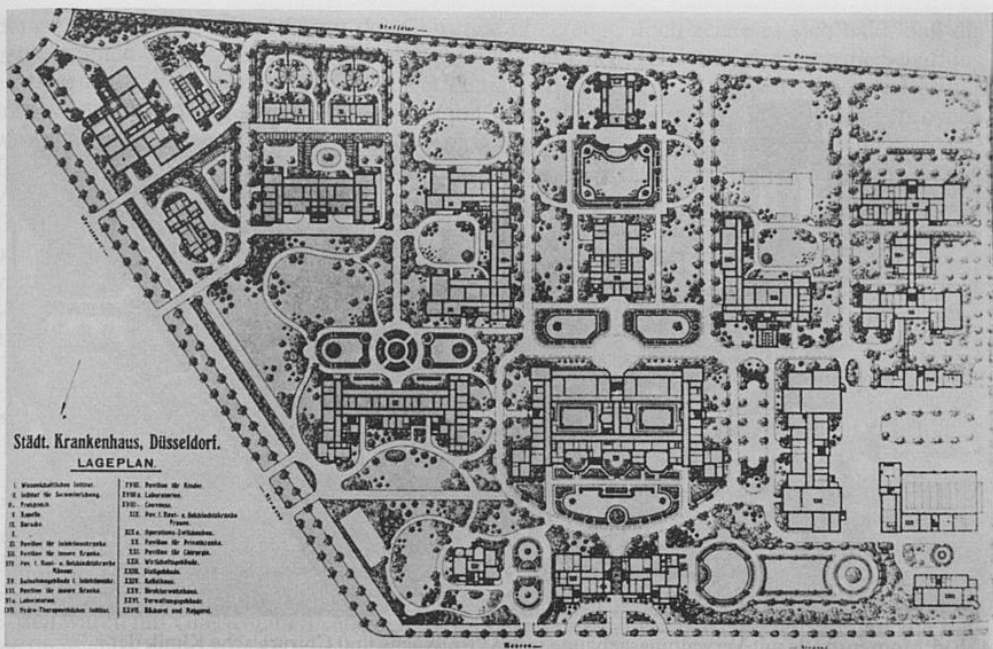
Lageplan der Städtischen Krankenanstalten Düsseldorf aus dem Jahre 1907.
